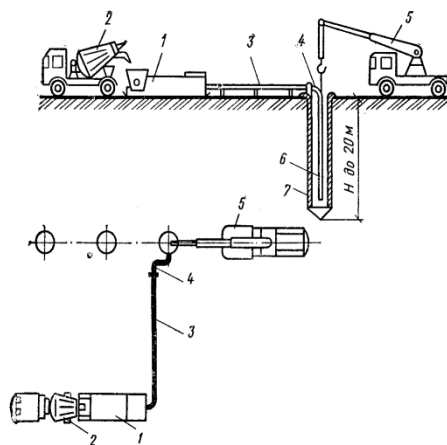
Бетонирование напорным методом свай глубокого заложения: 1 - бетононасос; 2 - автобетоносмеситель; 3 - инвентарный бетонопровод; 4 - компенсатор; 5 - автокран; 6 - напорный бетонопровод; 7 - обсадная труба.
